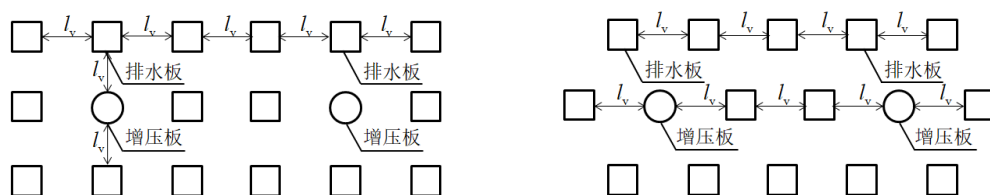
排水板及增压板正方形平面布置示意图 图 6.2.4-2 排水板及增压板等边三角形平面布置示意图
